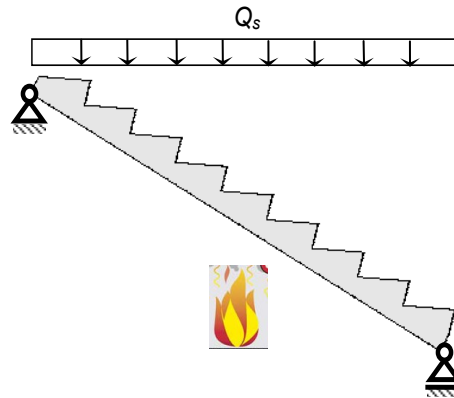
Розрахункова схема залізобетонного сходового маршу
